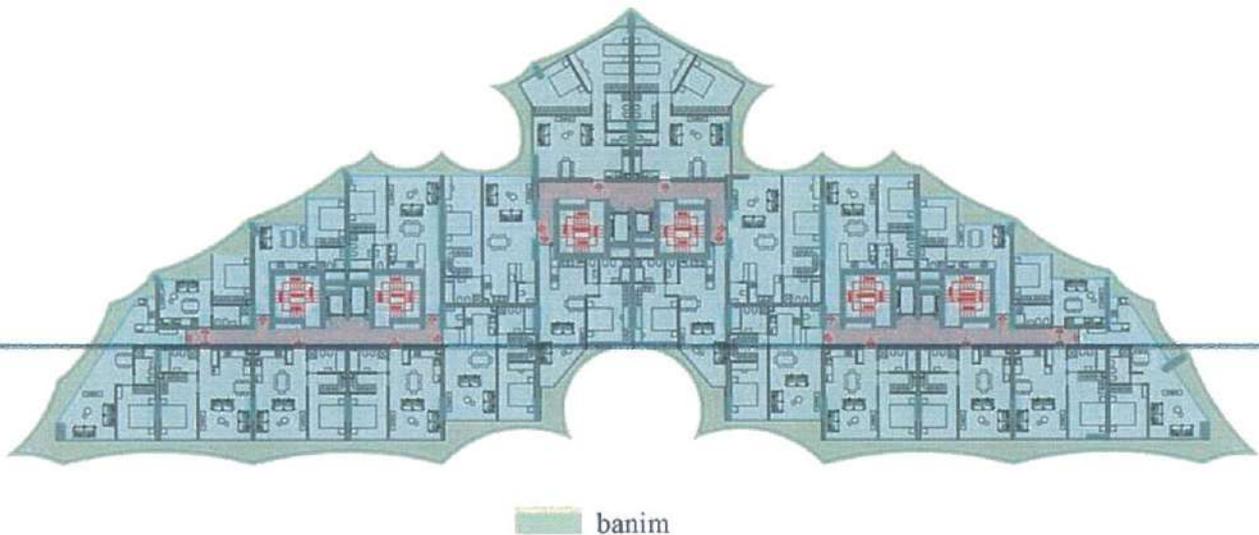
Ndarja e funksioneve brenda planimetrisë së kaitit tip
